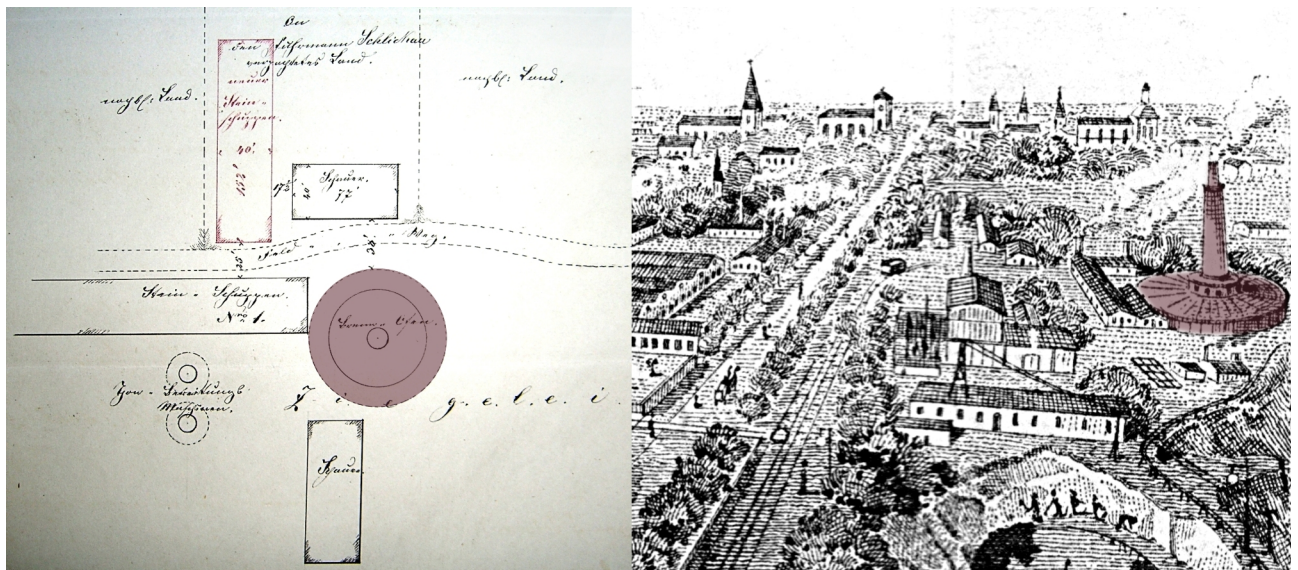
Lageplan, Ziegelei Wilschenbruch, 1866; Kalkfabrik Behr, um 1900
